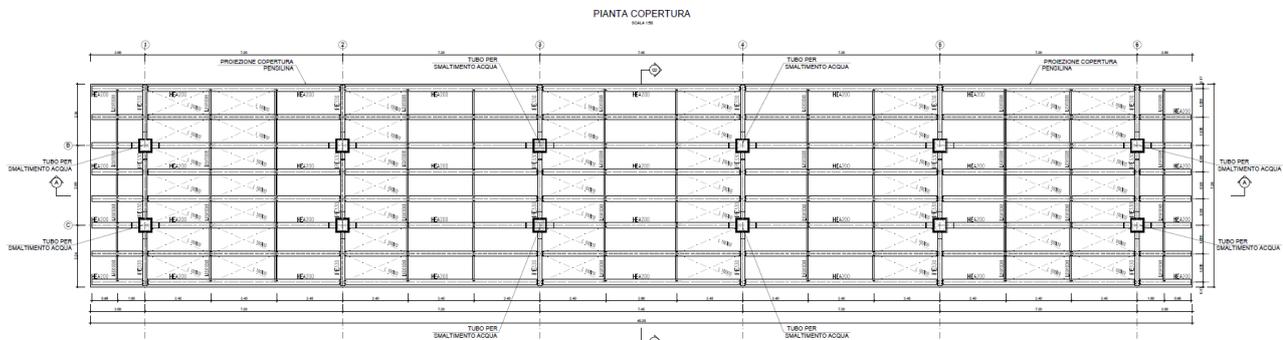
Pensilina fabbricato Tecnologico nella stazione di Ellera: pianta copertura
